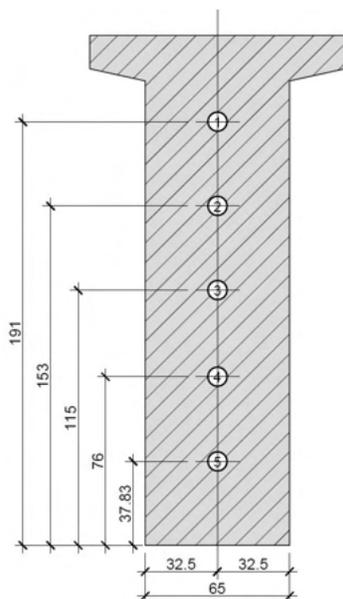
Modelo de seção de viga pré-moldada em concreto armado utilizada em passagem de fauna elevada
